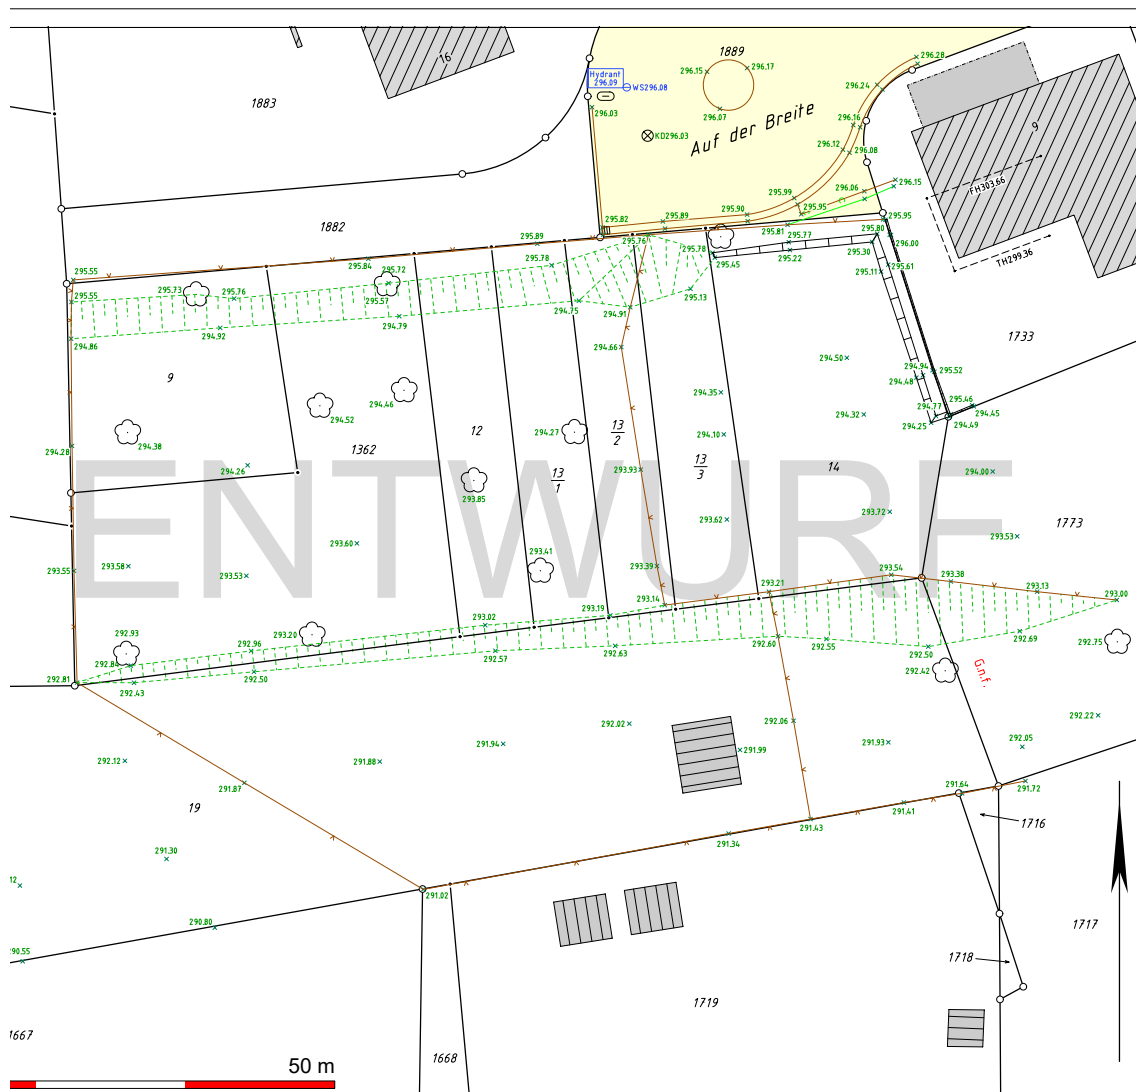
Ausschnitt aus Lageplan mit dem Plangebiet und Angaben von Höhen sowie von Gehölzen (Quelle: Ingenieurbüro Arnold, 2024)
